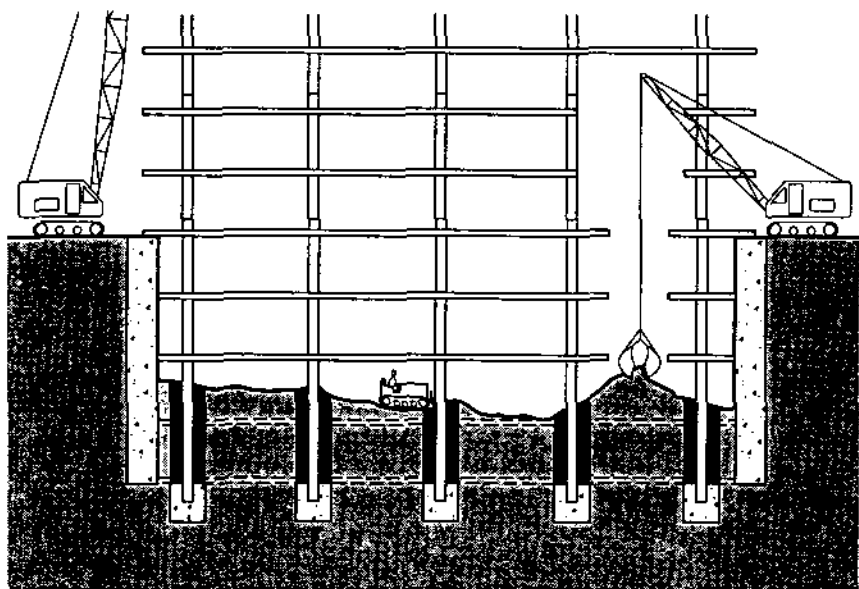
Возведение подземной части высотных зданий методом «стена в грунте»
